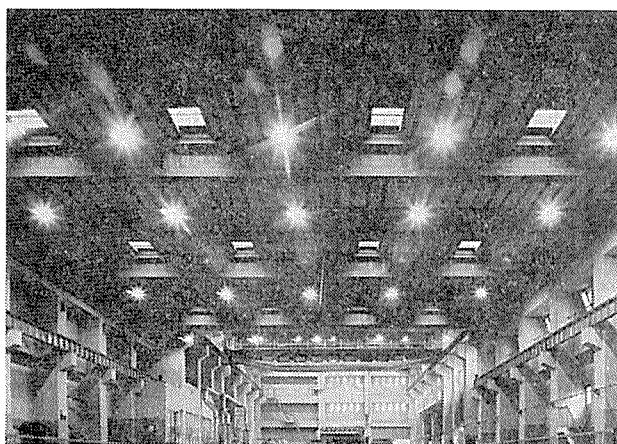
ポンプ室の屋根版に使用したダブルTスラブ
